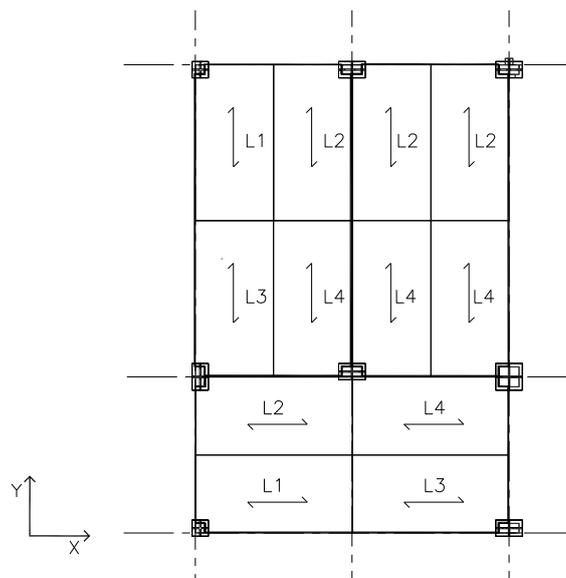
Planta da disposição das lajes pré-moldadas.
